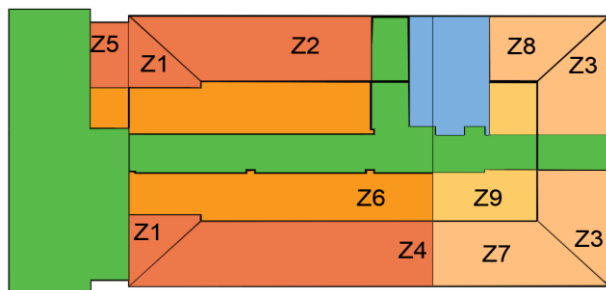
Zonas térmicas do segundo pavimento. Em verde: circulação; em azul: instalações sanitárias; em laranja: zona interna; em amarelo claro: zonas internas sobre o solo; em marrom claro: zonas perimetrais sobre o solo (Fonte: Elaborado pelos autores, 2022).
